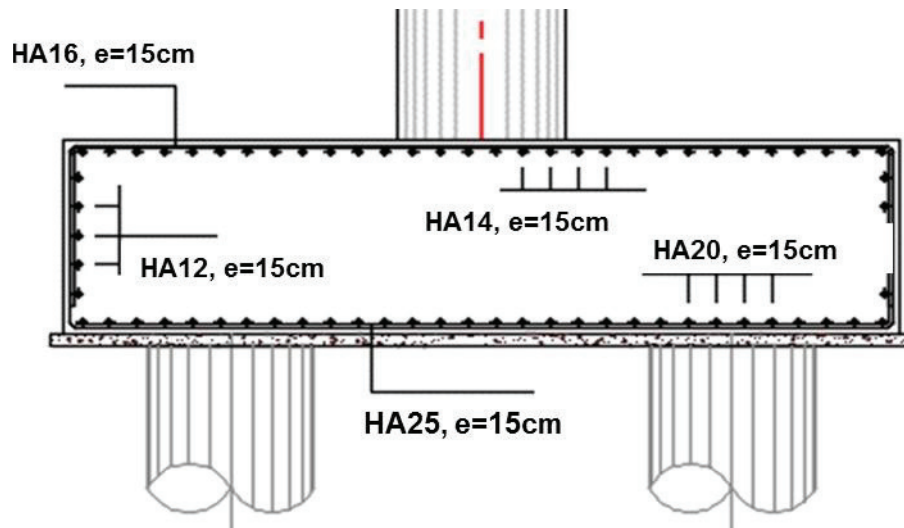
Croquis de ferrailage de la semelle sur piles.
